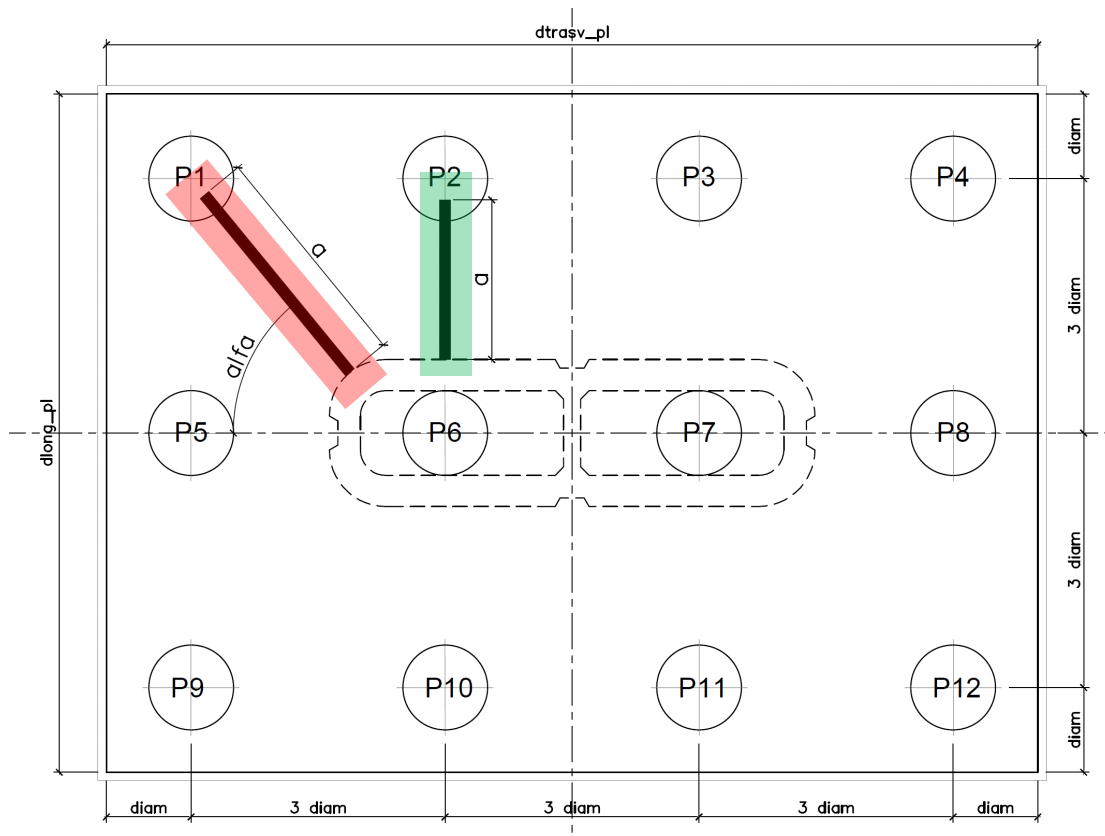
Vista in pianta - Tirante-puntone longitudinale (verde) e diagonale (rosso) – $\alpha = 51^\circ$
